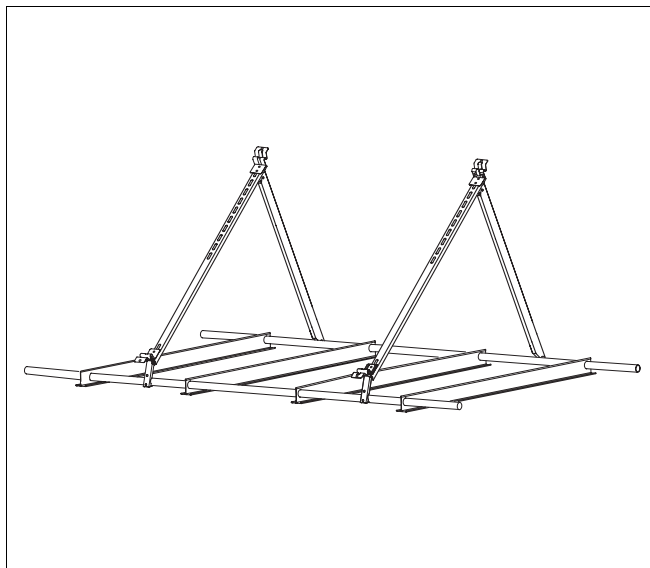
Vista general de los soportes para tejado plano, modelo horizontal para un colector
